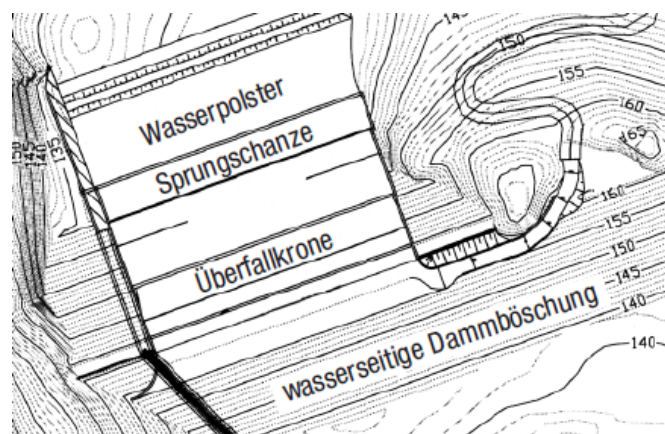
Lageplan A'Sarooj Damm (29, Kleist 2003)
